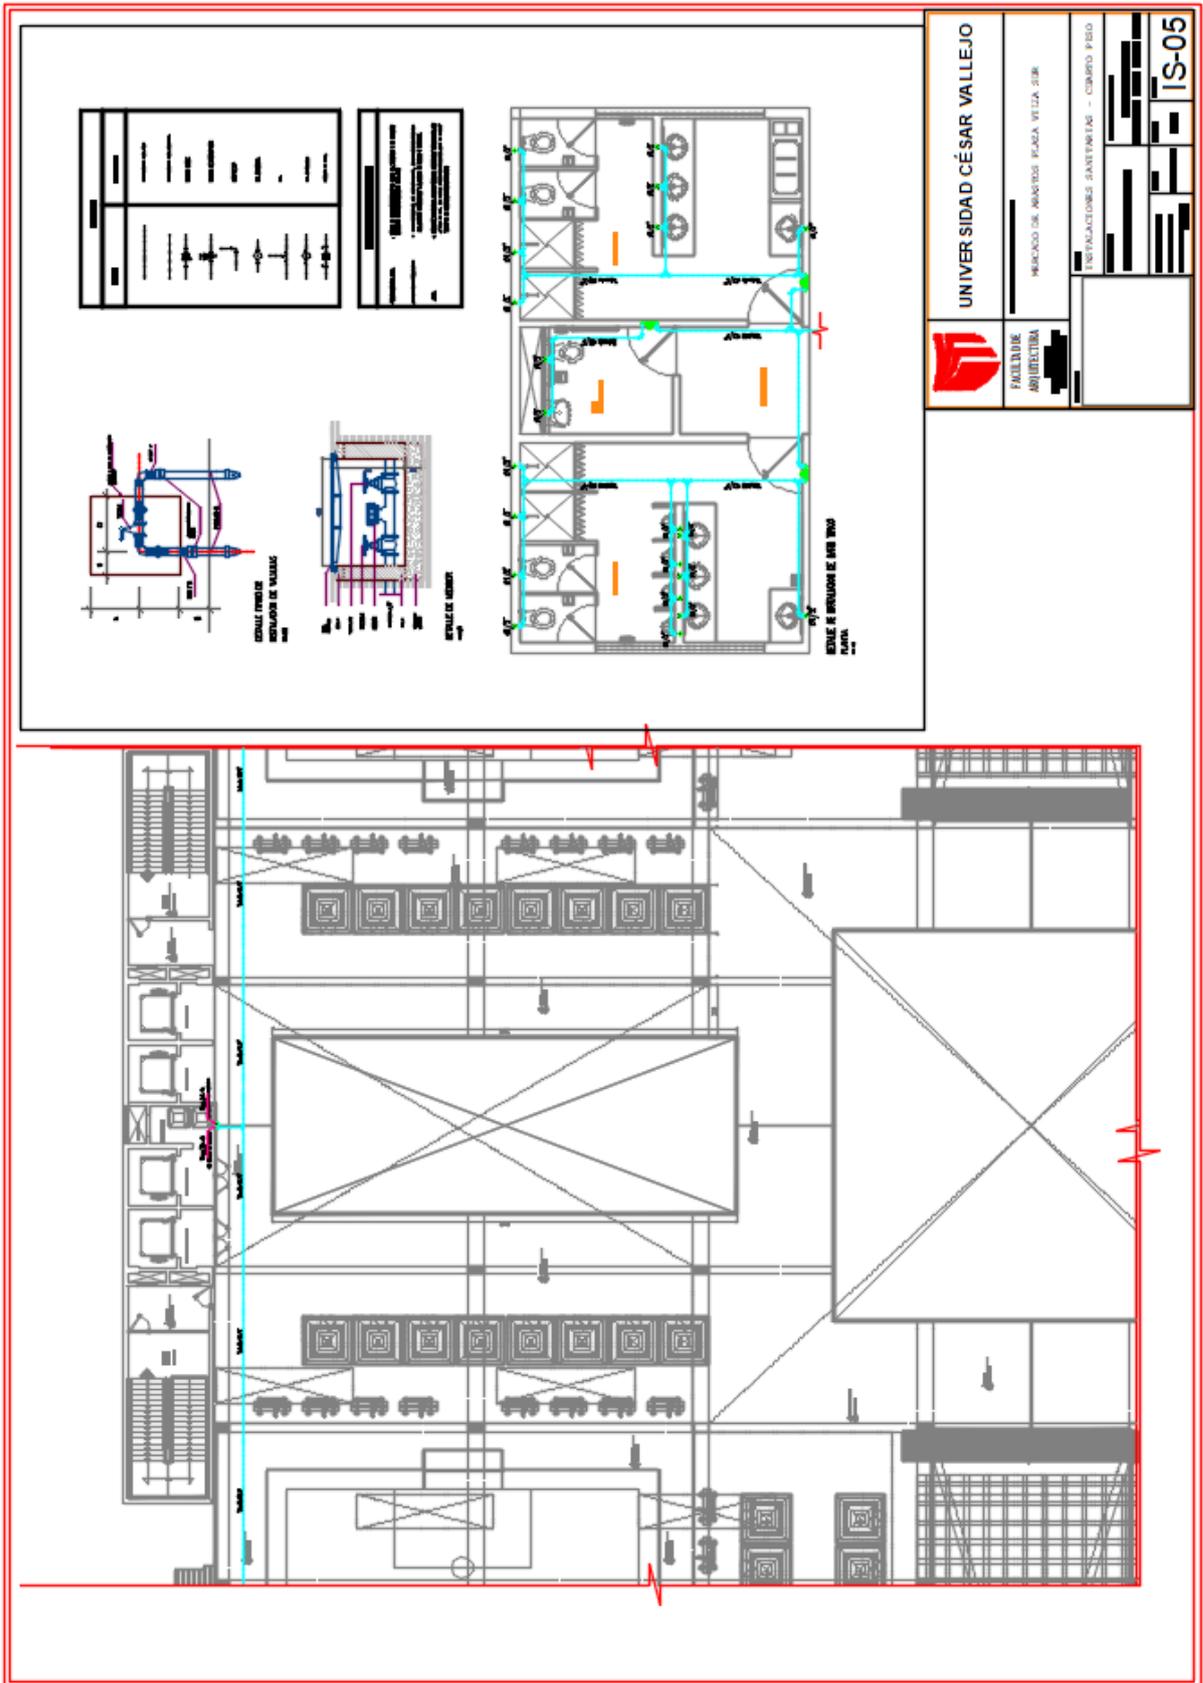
Plano de Sanitarias – Plano de instalaciones de Agua – cuarto piso.
